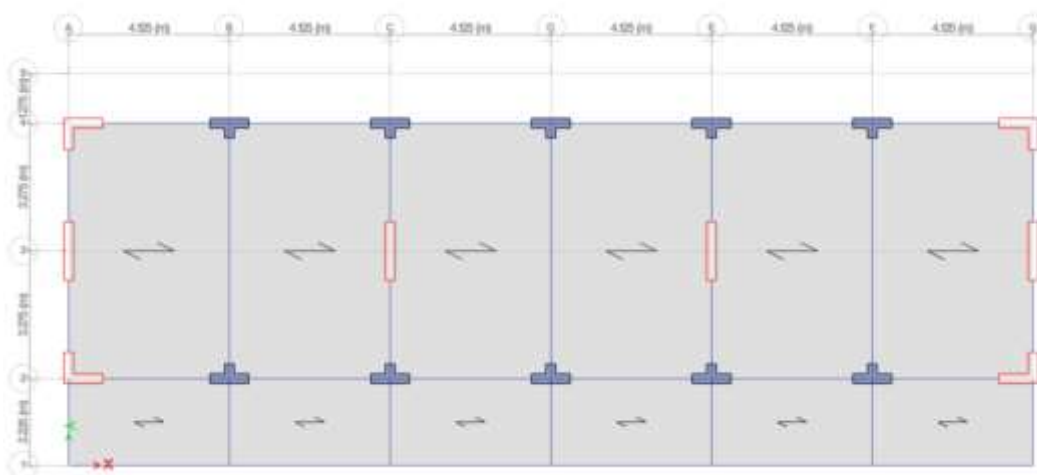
Planta típica del módulo de aulas de 3 pisos.
